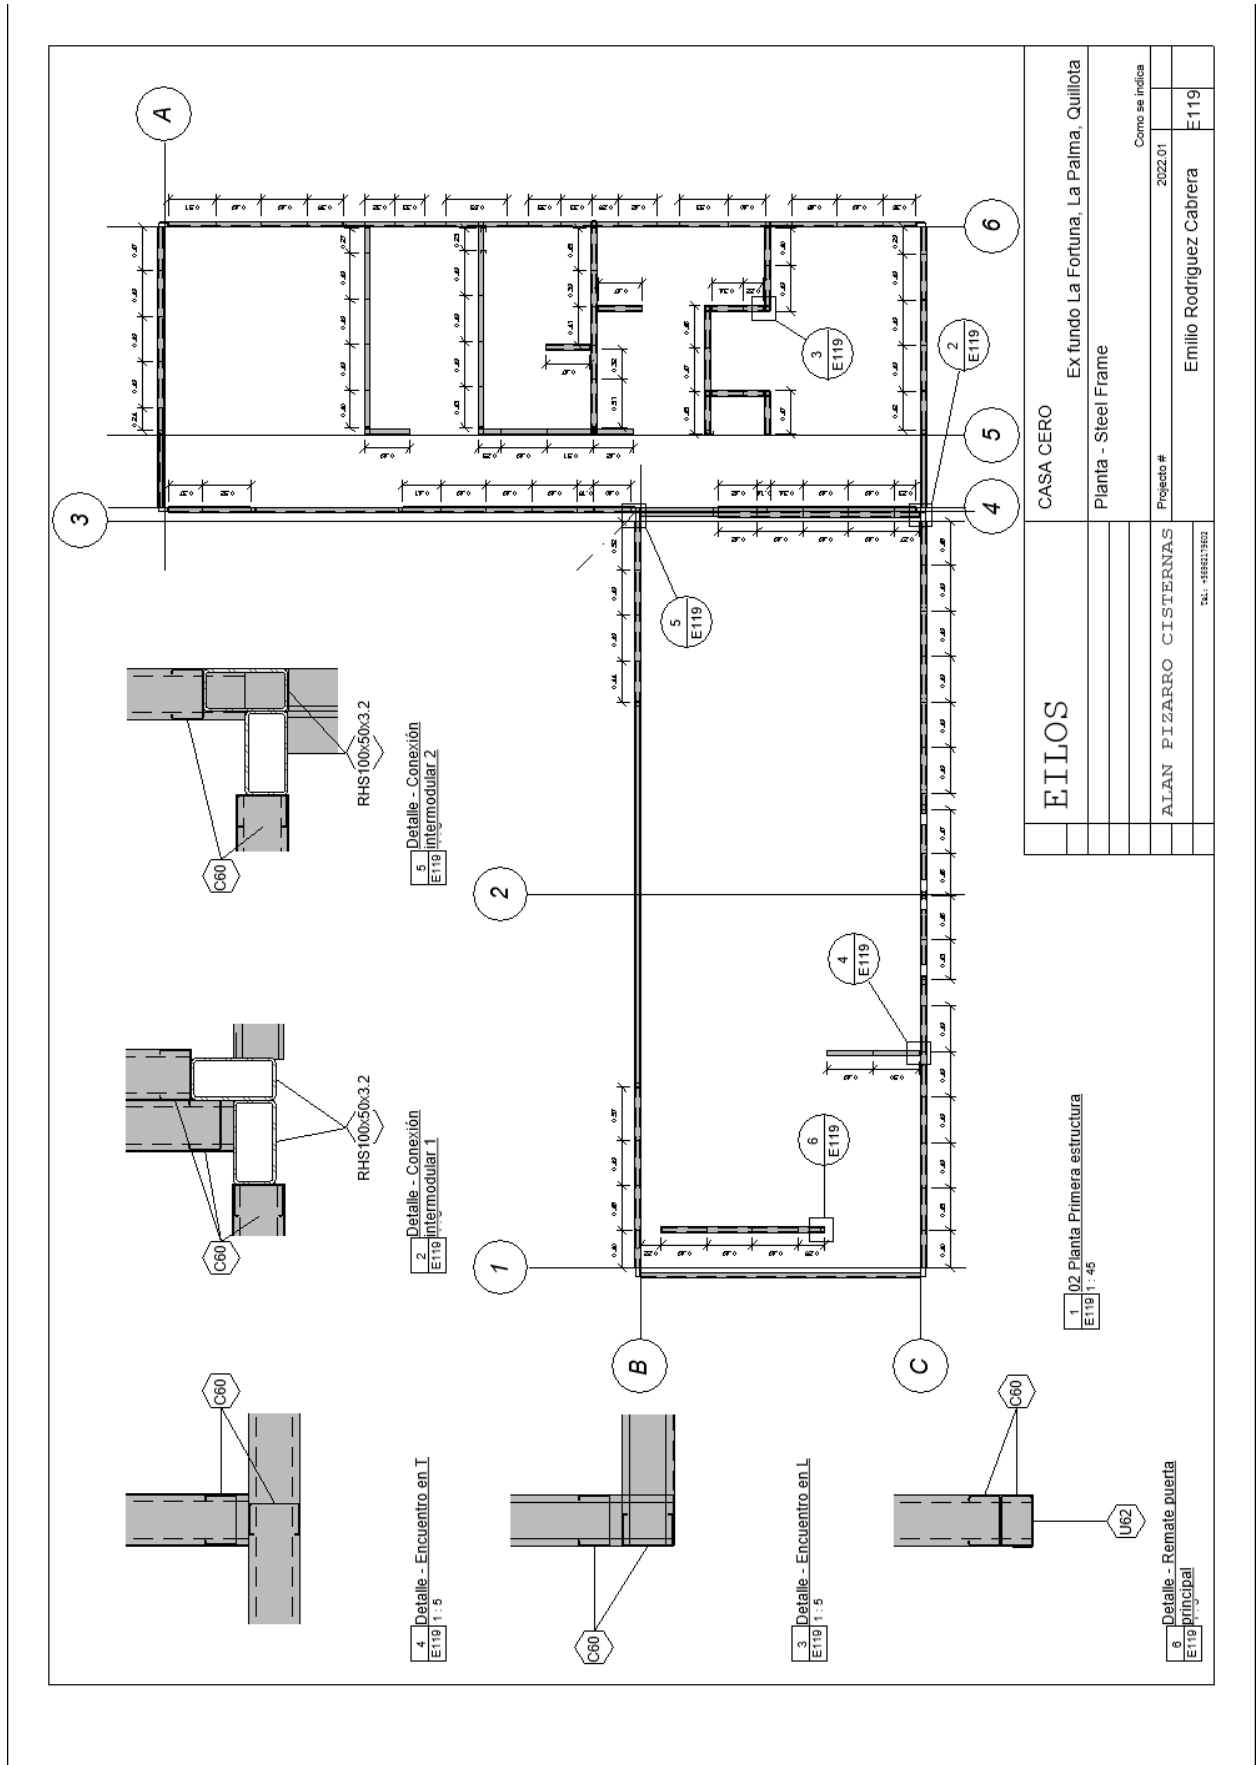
Plano de Planta Steel Frame con Detalles de Uniones.
